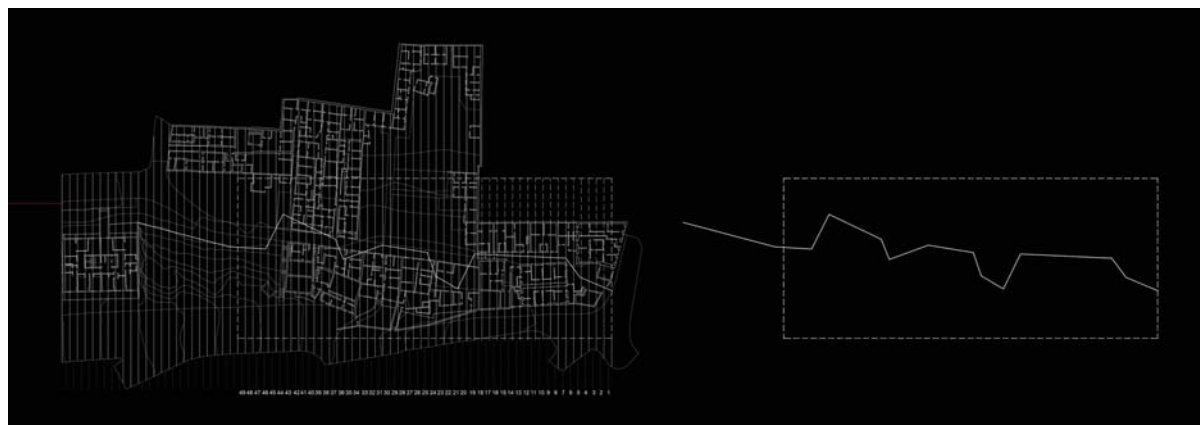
Planta final do limite através do traçado planimétrico, e. a., 2017.
